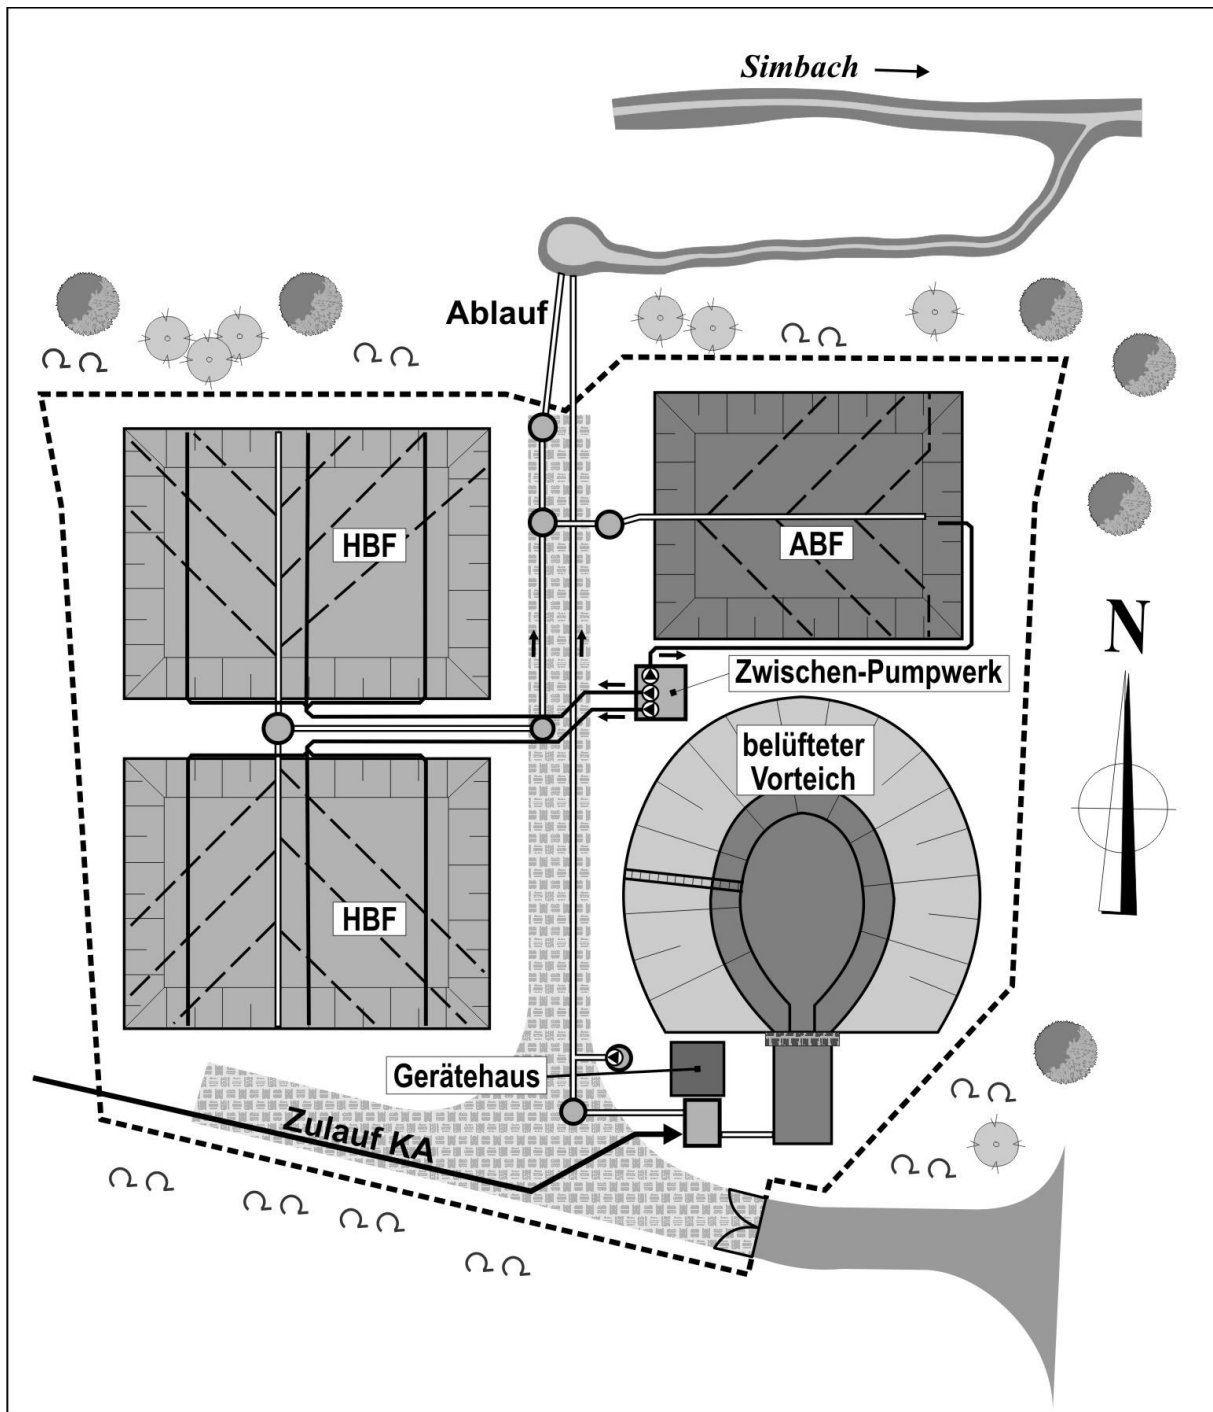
Lageplan zur Kläranlage Seyweiler
